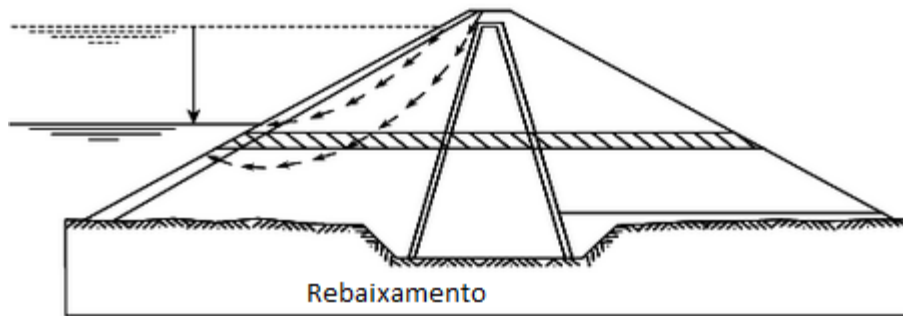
Carregamento em uma barragem: rebaixamento (Assis, 2014)
